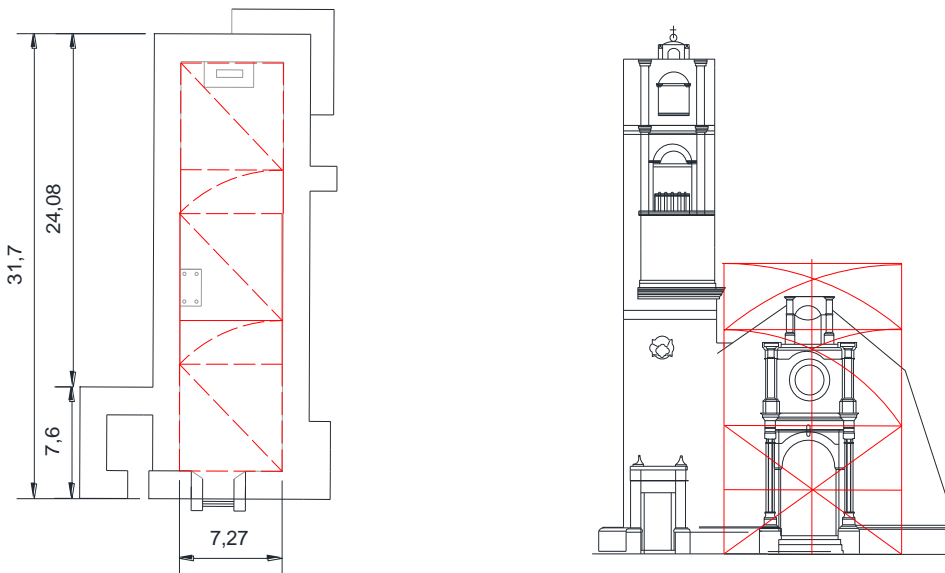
Trazo de la planta arquitectónica y fachada de la capilla de Santa María de la Luz, Realizo J. O. B.
